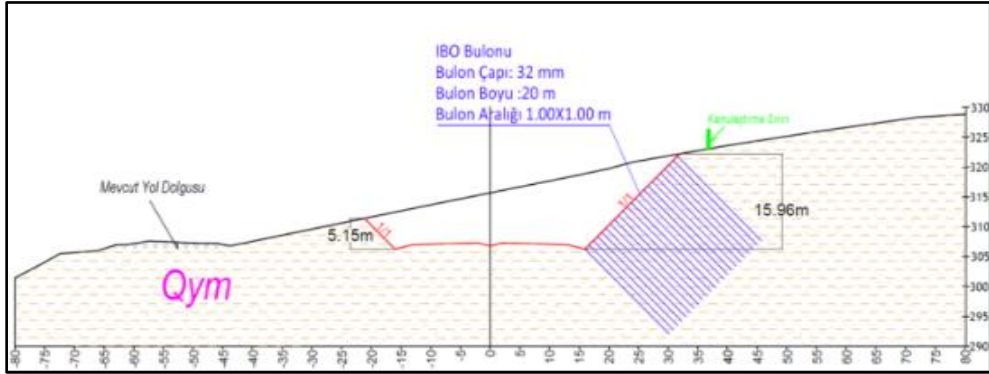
'da gösterilen 3 nolu alternatifte, 2Y/3D eğimle gösterilen ilk şevde 20m uzunluğunda 1.00 X 1.00 m kareli IBO bulon, tek kat hasır çelik ve 15 cm kalınlığında püskürtme beton uygulanması önerilmiştir. İkinci şevde
